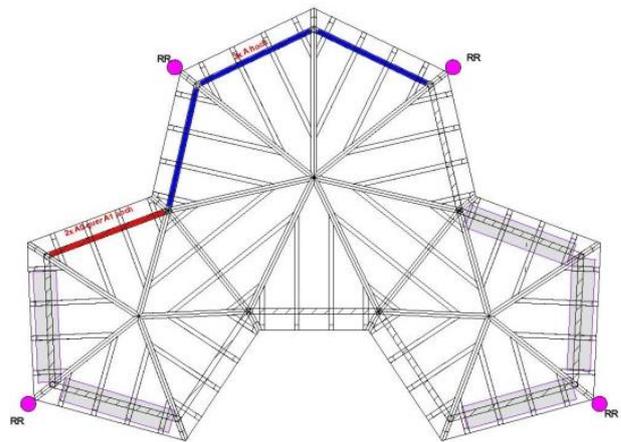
Grundriss des Pavillons Baumkraftwurz
